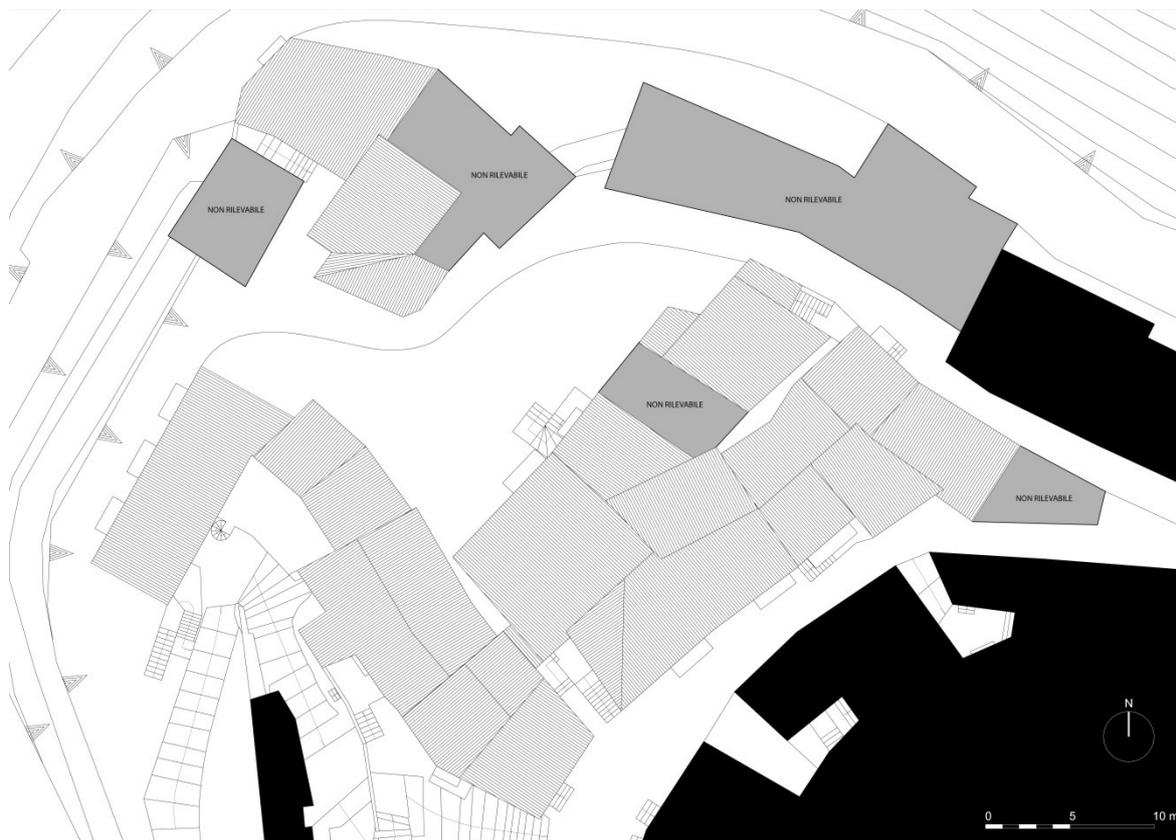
Comparto n°3 / Planimetria delle coperture
